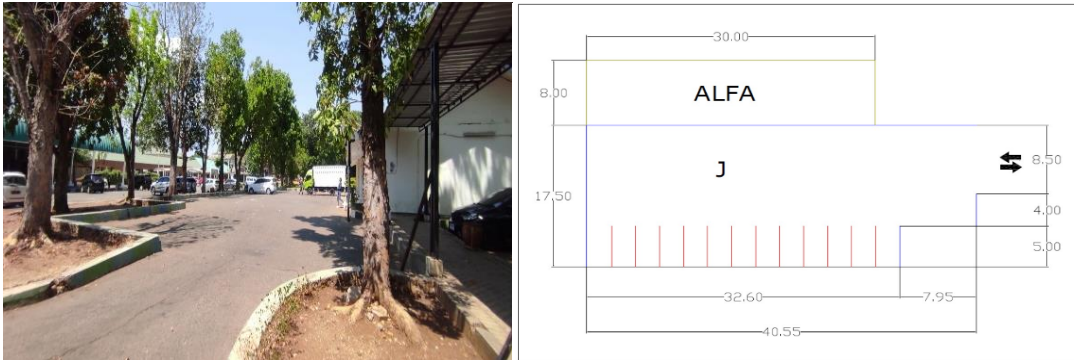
Foto dan Skesa Lahan Parkir I
